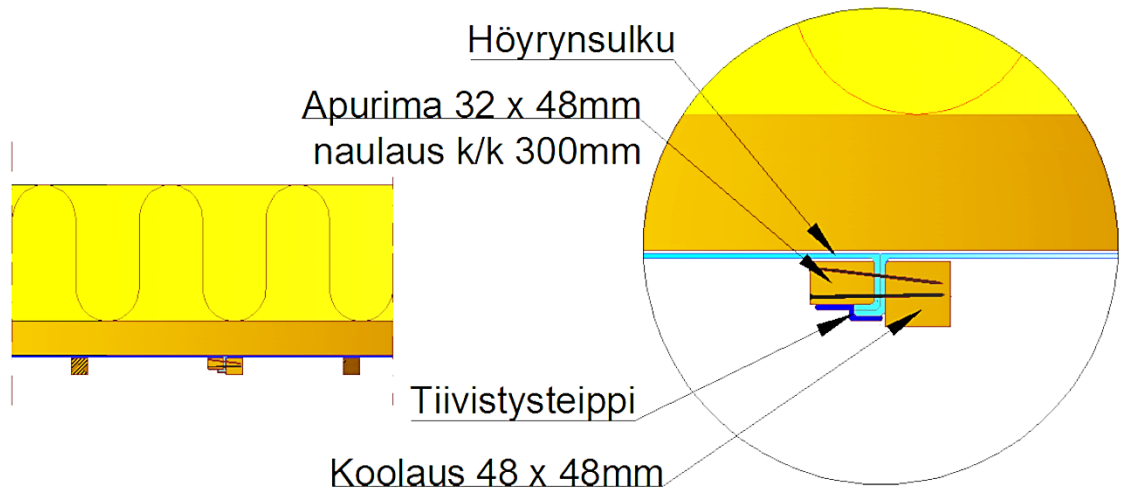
on esitetty ulkoseinärakenteessa oleva höyrynsulun jatkoskohta. Tiivistyslistana voidaan käyttää esimerkiksi 0,5mm galvanoitua teräslevyä tai 6 – 9mm vaneria. Käytettäessä teräslevyä, voidaan levy asentaa koko runkotolpan matkalle. Vaneria käytettäessä on vaakaan asennettu ristikoolaus asennettava ensin ja vaneri asennetaan koolauksen väliin. Ohuen listan tarkoituksena on ”syödä” eristetilaa mahdollisimman vähän, joten siitä ei aiheudu kylmäsiltaa rakenteeseen. Kiinnitysväli tulee olla maksimissaan 300mm.
